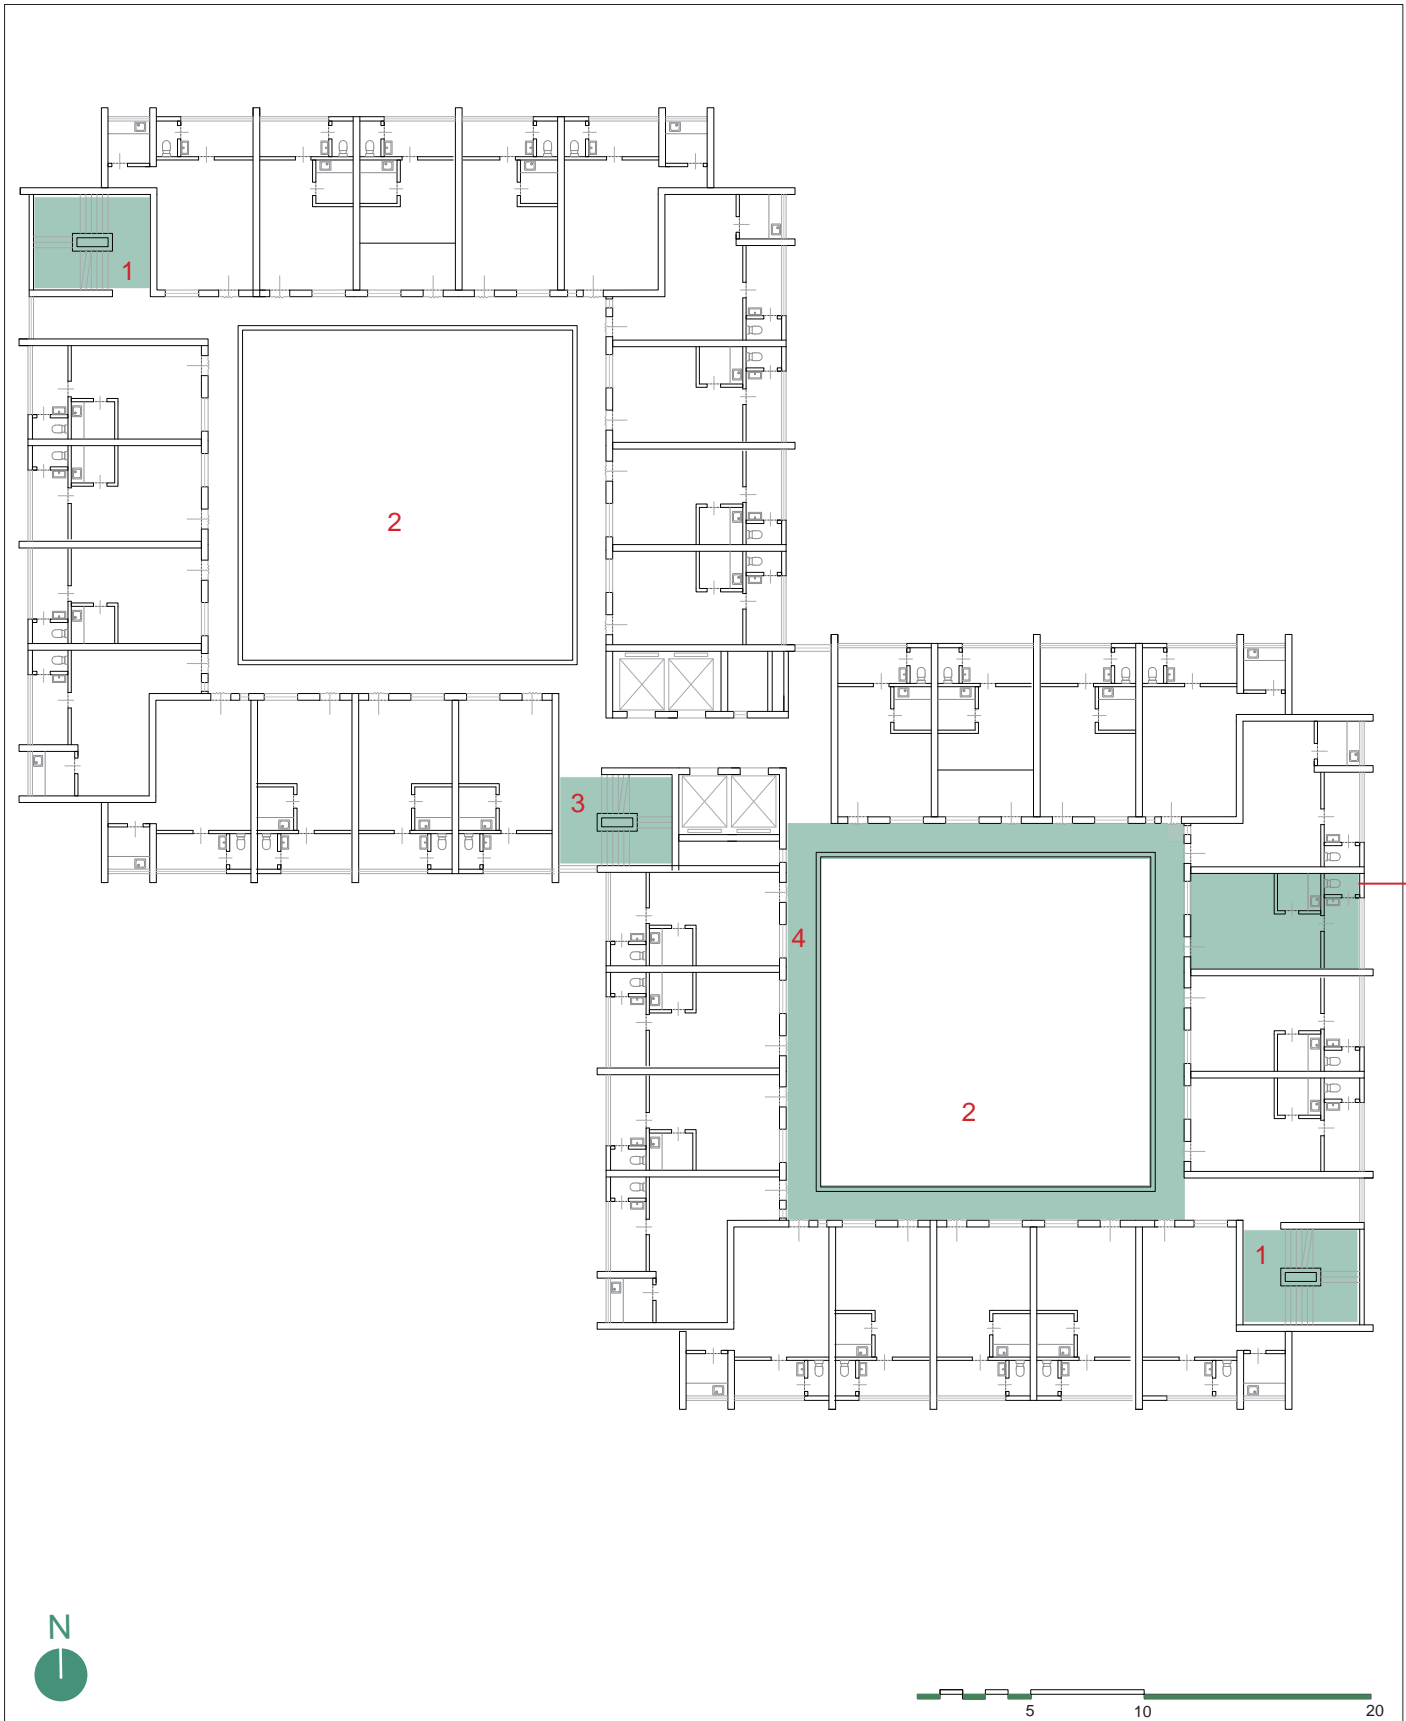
Grundrissplan - Regelgeschoss - Chuk Yuen South
